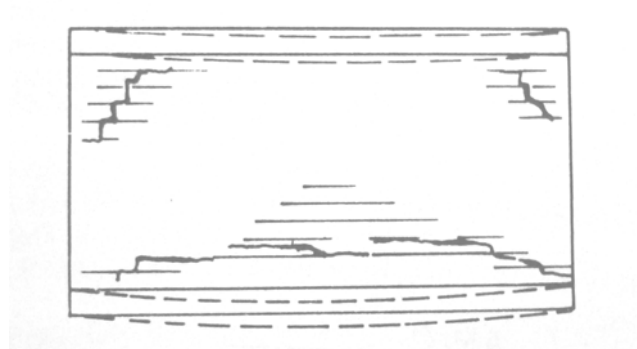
Trincas em parede de vedação: deformação do suporte maior que a deformação da viga superior. (Fonte: THOMAZ)
